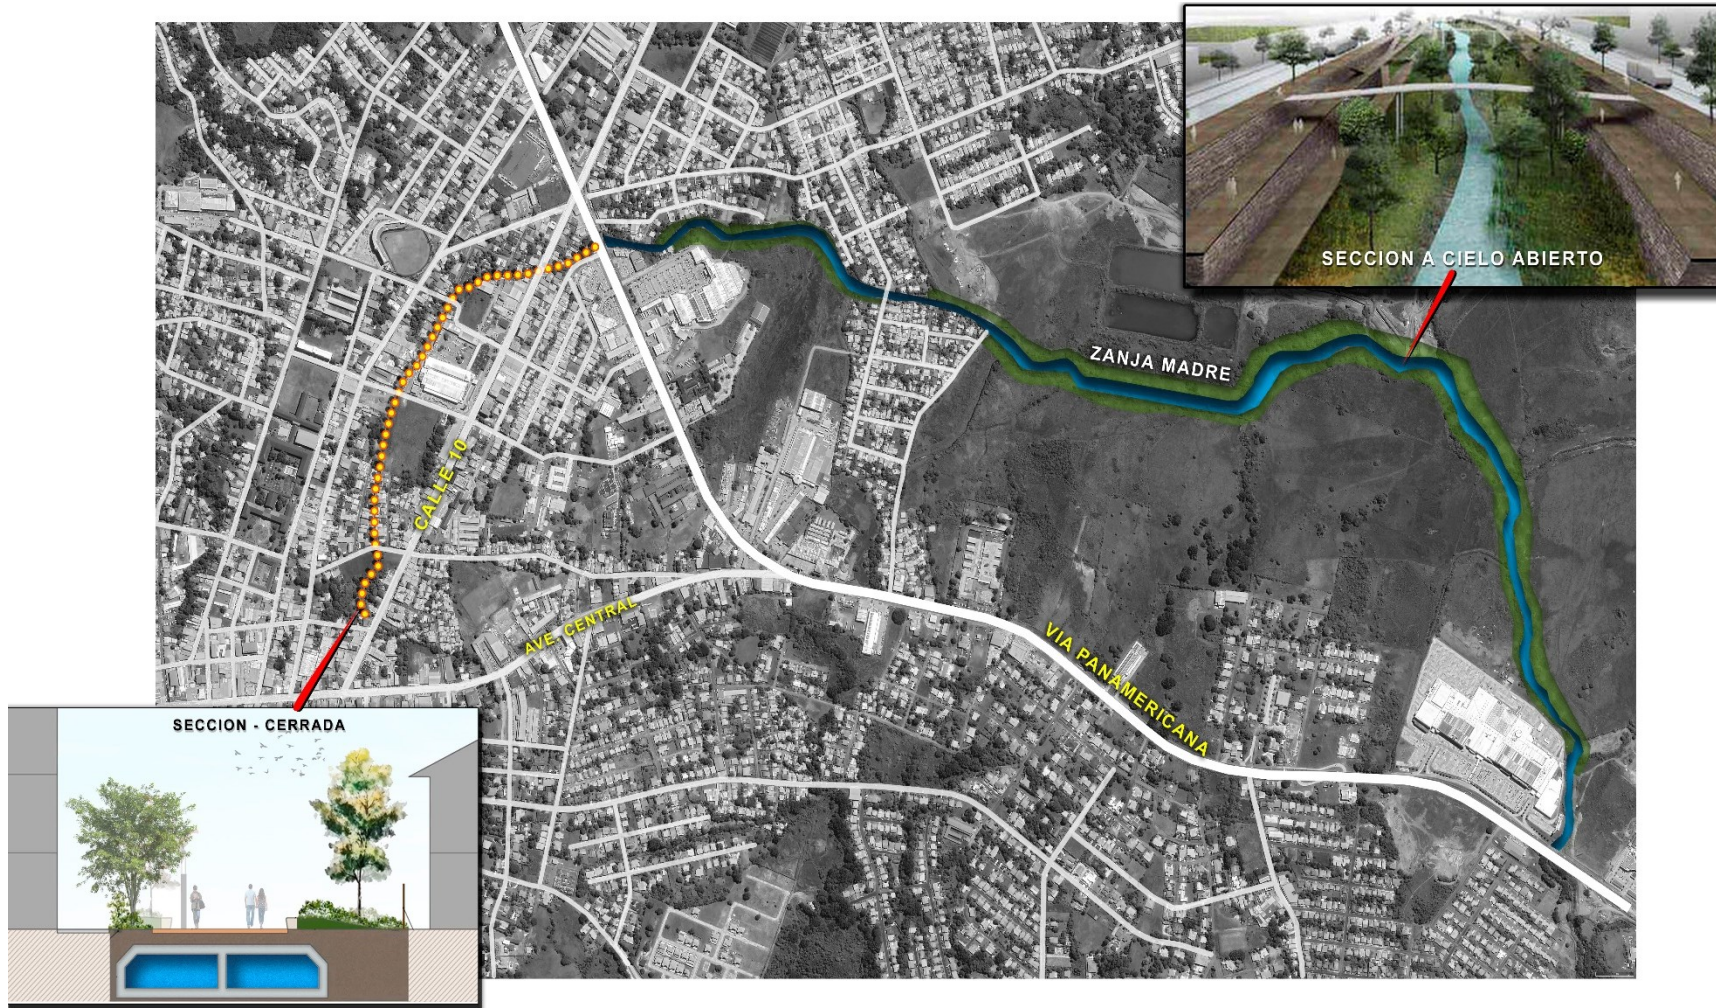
Proyecto Rehabilitación de la Zanja Madre. Fuente: Equipo Consultor
